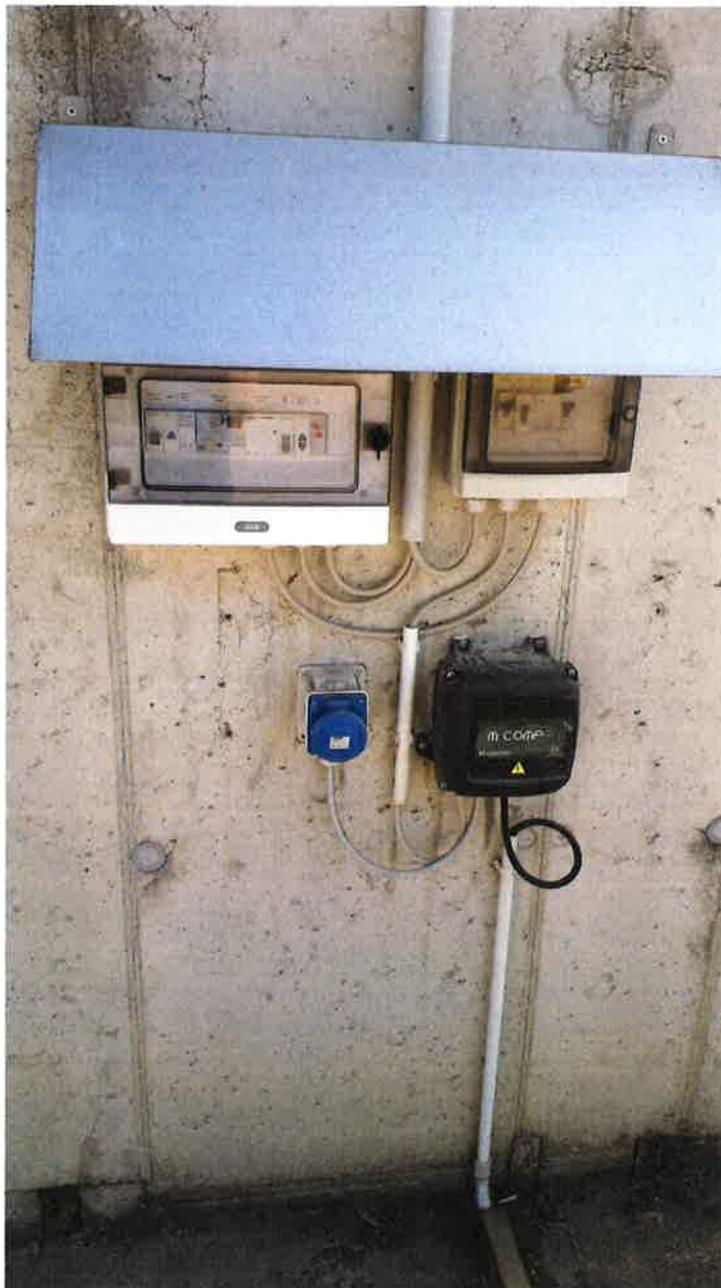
quadro elettrico di comando e di controllo della pompa di sollevamento, posizionato sul muro che delimita la proprietà lungo via Mottolo, nei pressi dell'impianto specifico.
